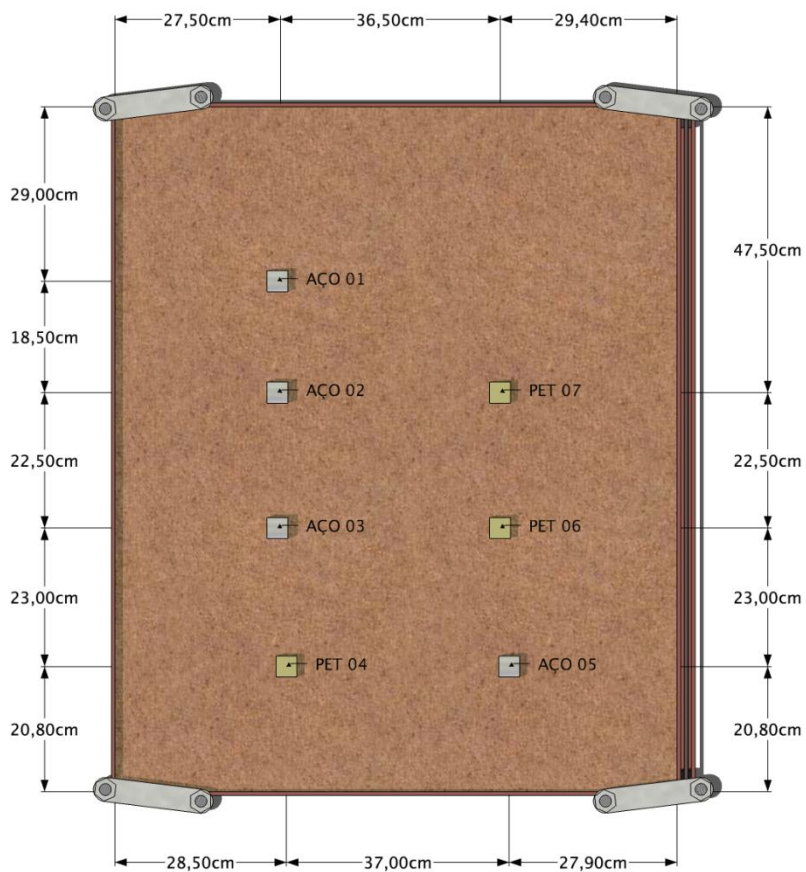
LOCAÇÃO DAS ESTACAS NA CAIXA DE AREIA DURANTE SEGUNDA BATERIA DE ENSAIOS EM PLANTA BAIXA ESQUEMÁTICA.
